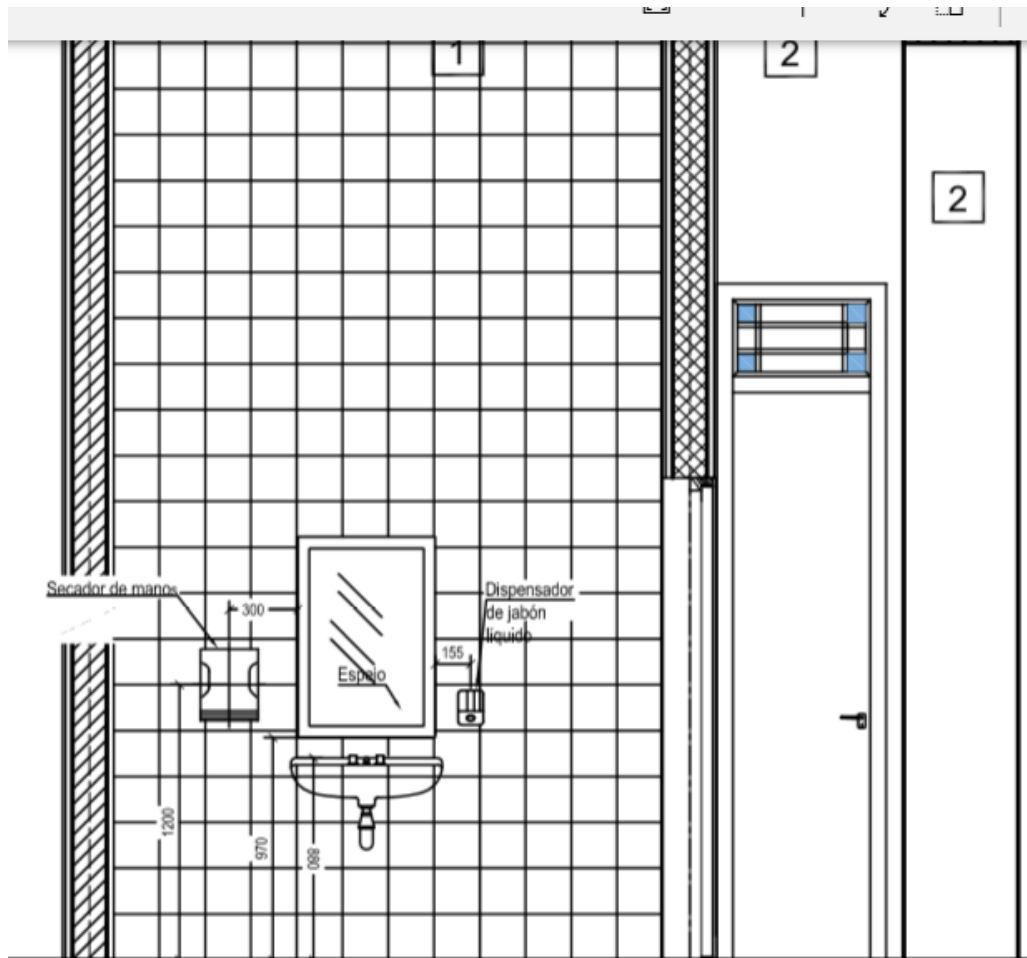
Corte 5. Acabado de revestimiento. Propuesta
